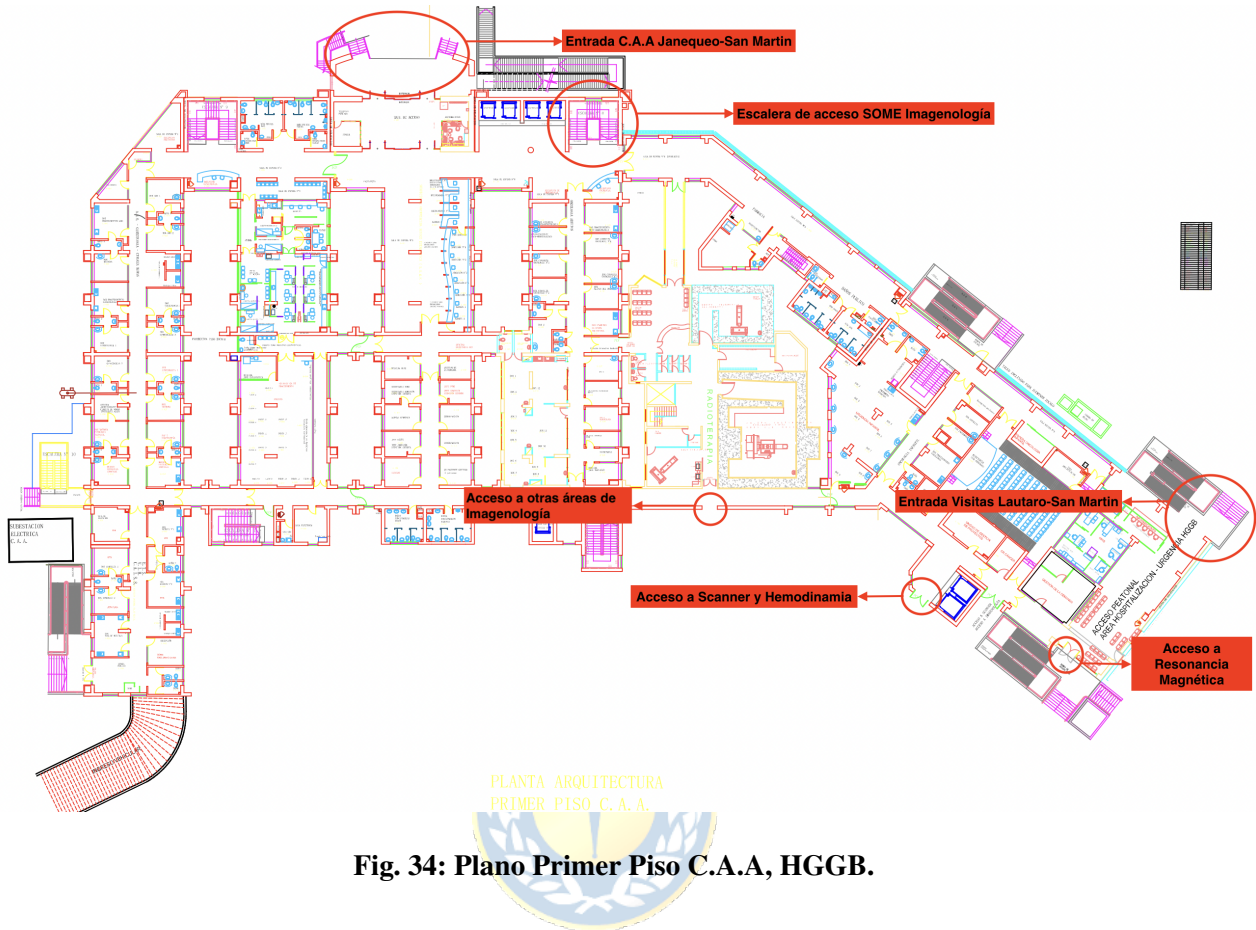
Plano Primer Piso C.A.A, HGGB.
